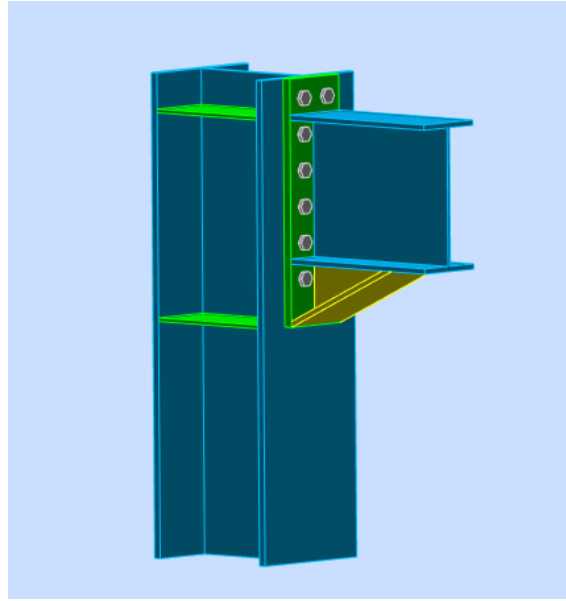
Schéma de l'assemblage poutre – poteau.
